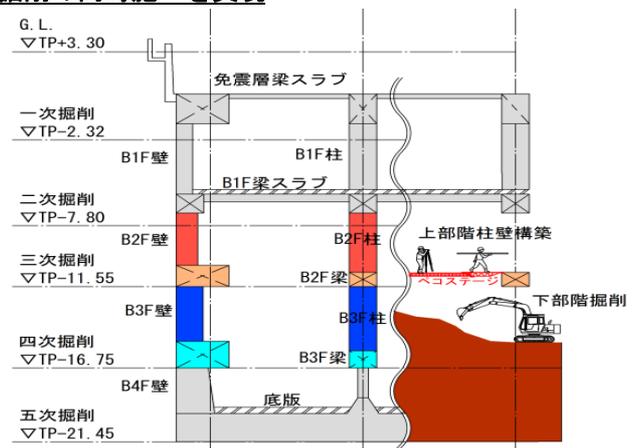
躯体形状詳細図、上部階構築と下部階掘削の同時施工図
